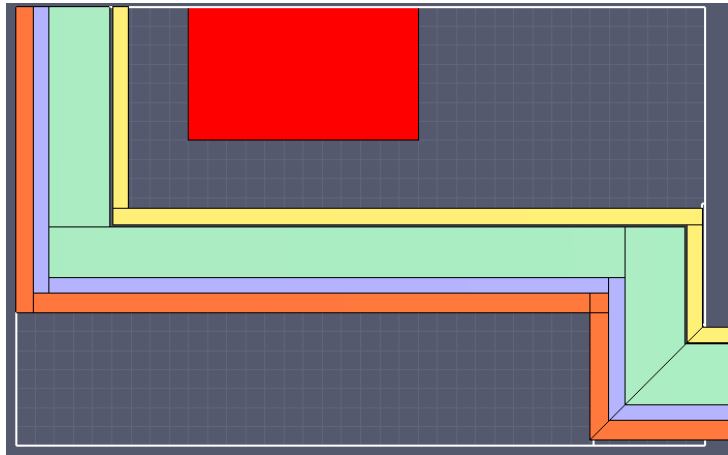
План розташування чотиришарового блока фасаду будівлі
